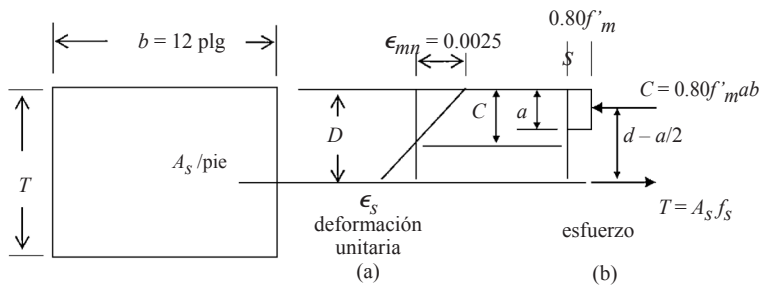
Espesor de un pie del muro de mampostería que no es de carga que muestra el bloque de esfuerzos de la mampostería
